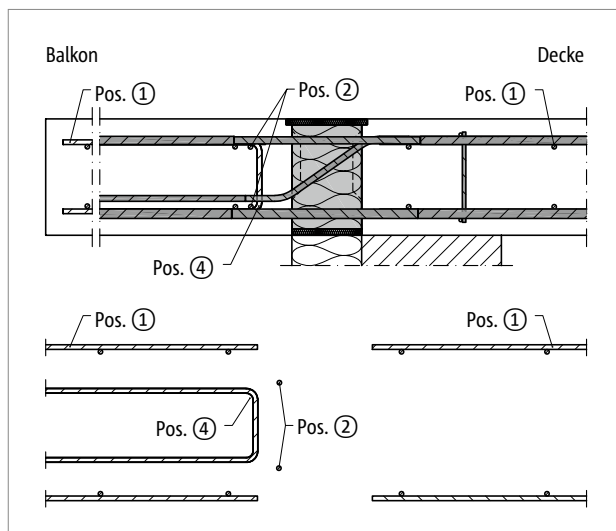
Schöck Isokorb® XT Typ K-M12 bis M13: Bauseitige Bewehrung bei direkter Lagerung
